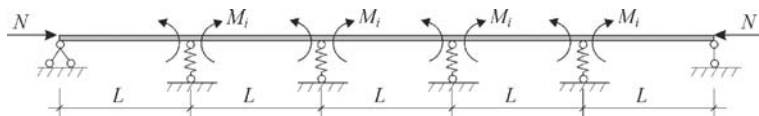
Расчетная схема верхнего пояса на упругих опорах
